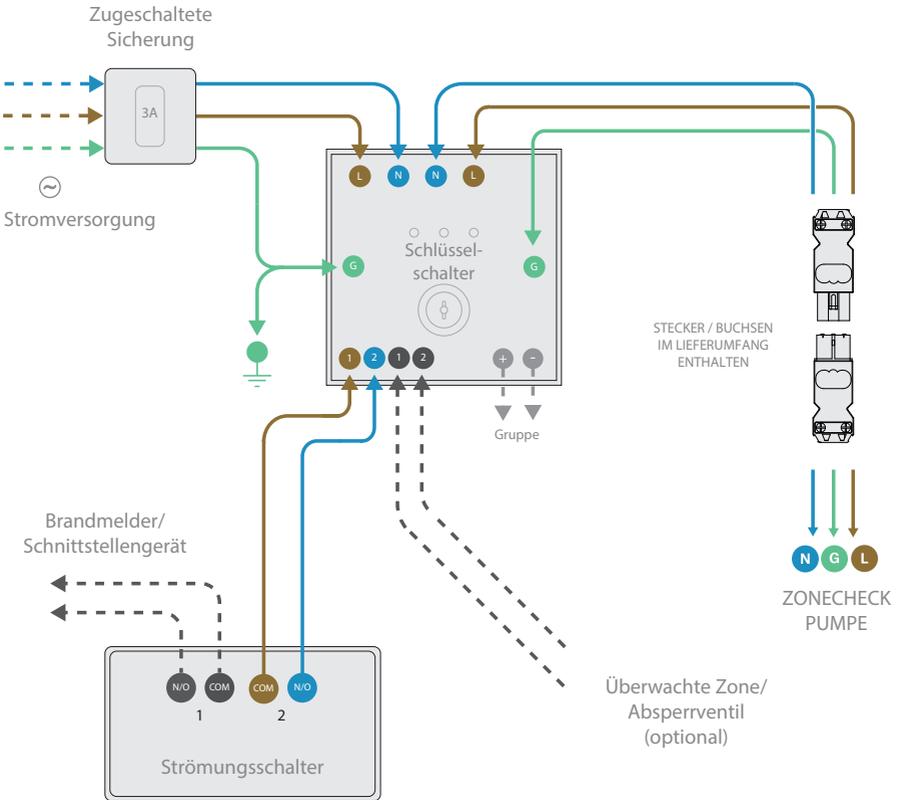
Anschlußplan Zonecheck mit Schlüsselschalter
